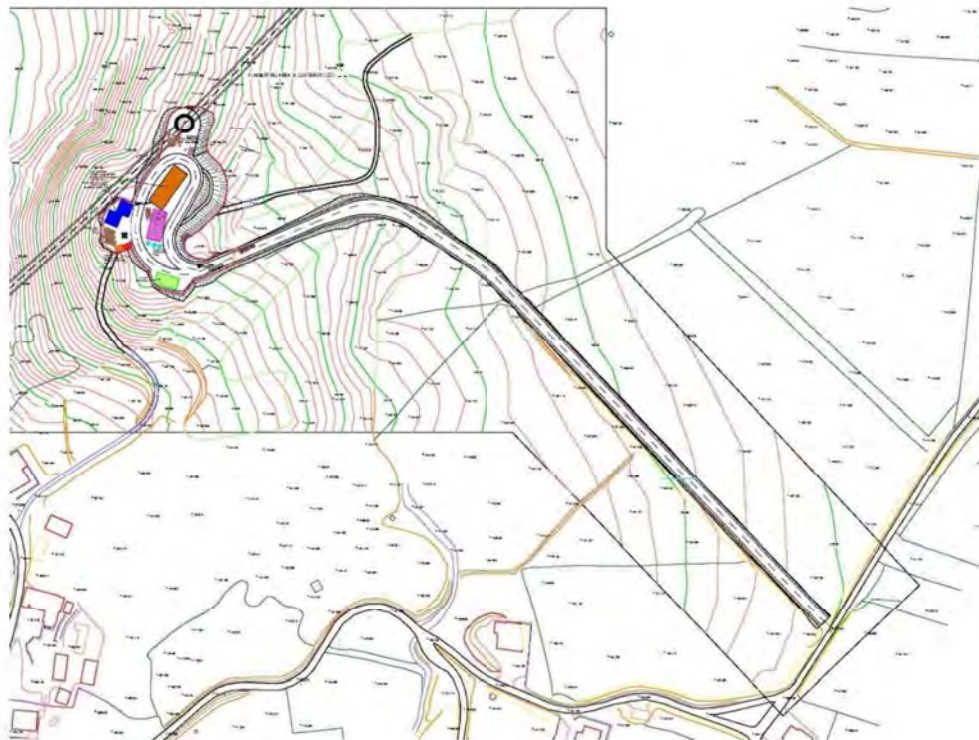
Planimetria area Pozzo Piezometrico, Opere propedeutiche – Viabilità di accesso.
